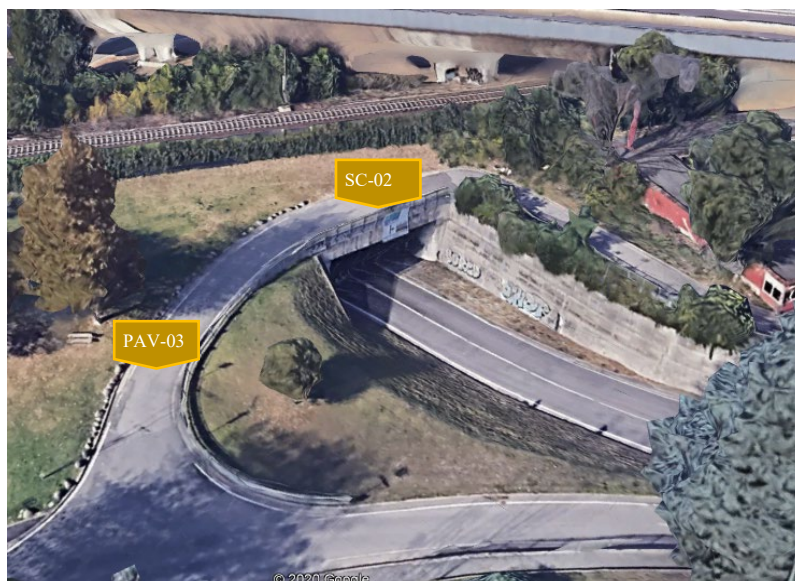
Foto 3D Google Earth – Strada e Galleria da demolire
